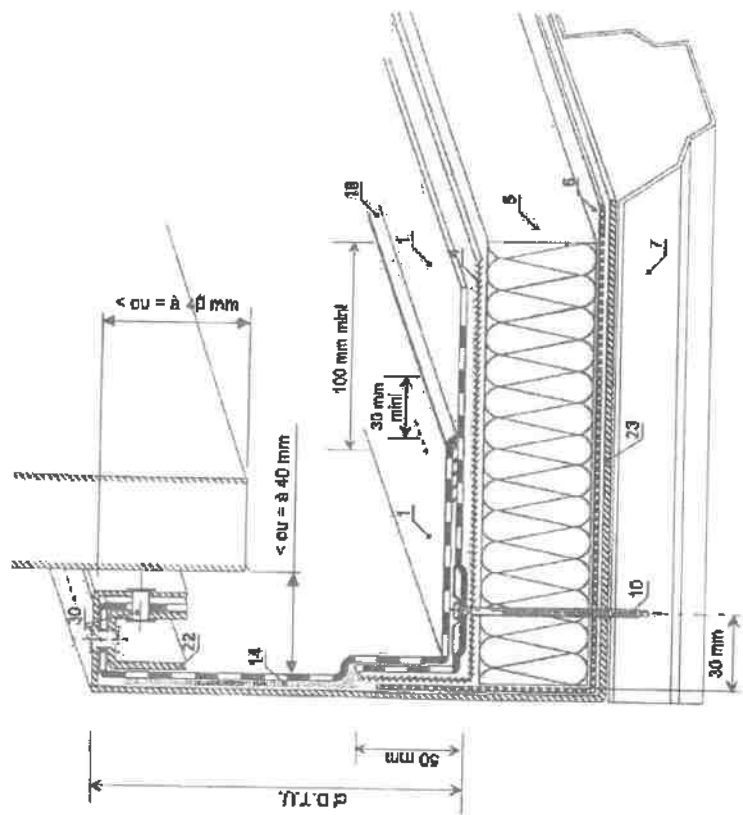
Relevé d'étanchéité - Coupe sur bac acier travaux neufs
